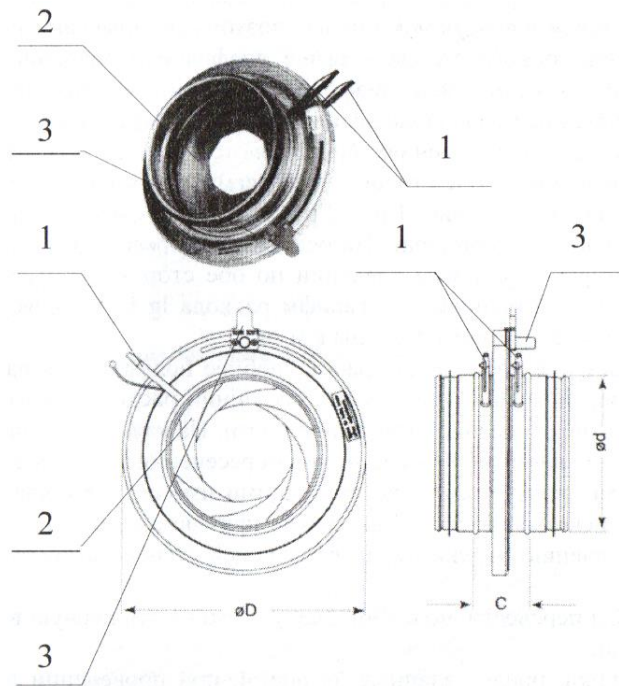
Конструкция ирисовой диафрагмы: 1 – штуцеры отборников статического давления; 2 – «лепестки» ирисовой диафрагмы; 3 – рычаг, перемещением которого изменяется диаметр отверстия для прохода воздуха
